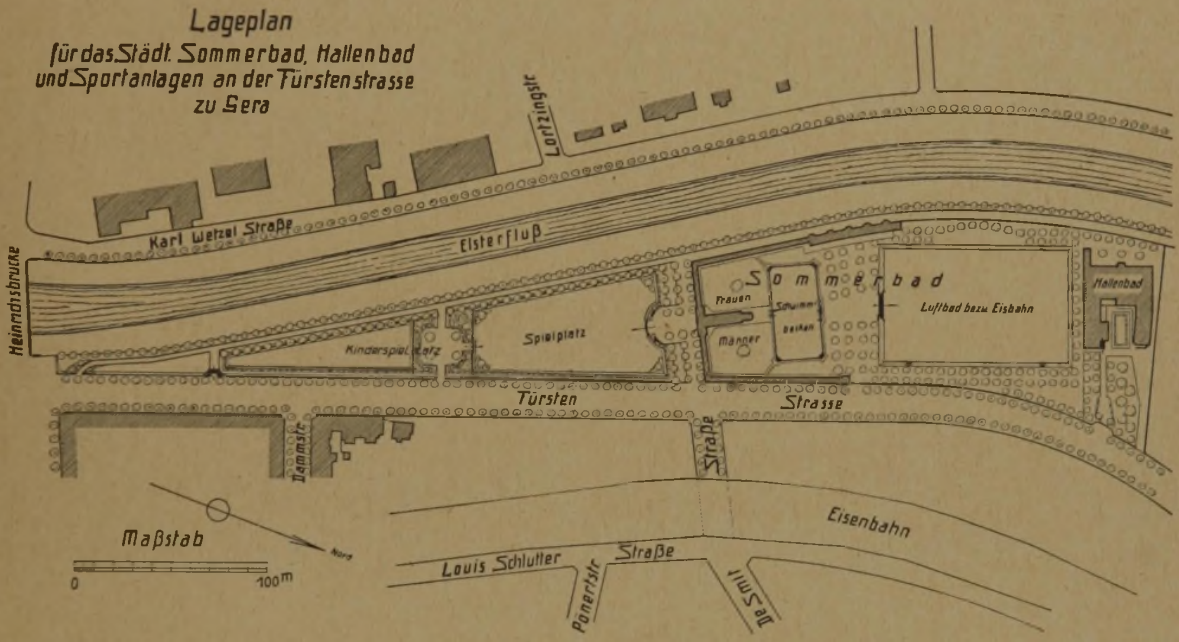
Lageplan der Gesamtanlage. (1 : 4000).
